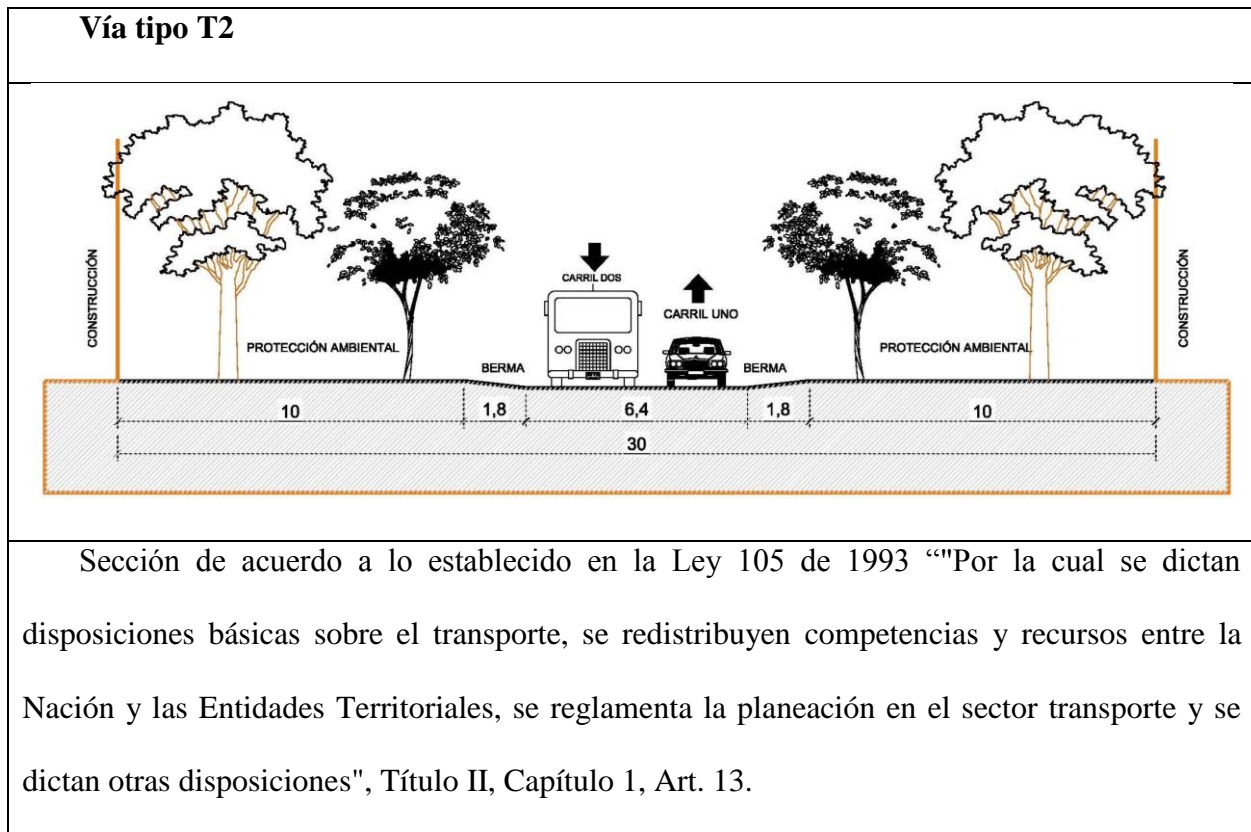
Perfil vial tipo T2. Fuente: POT Barrancabermeja.
